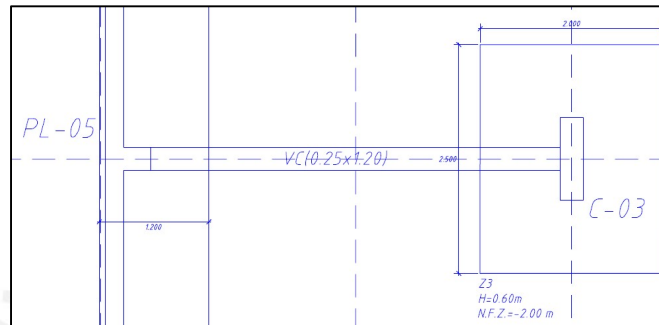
Vista en planta Zapatas conectadas Z3 y Z7
